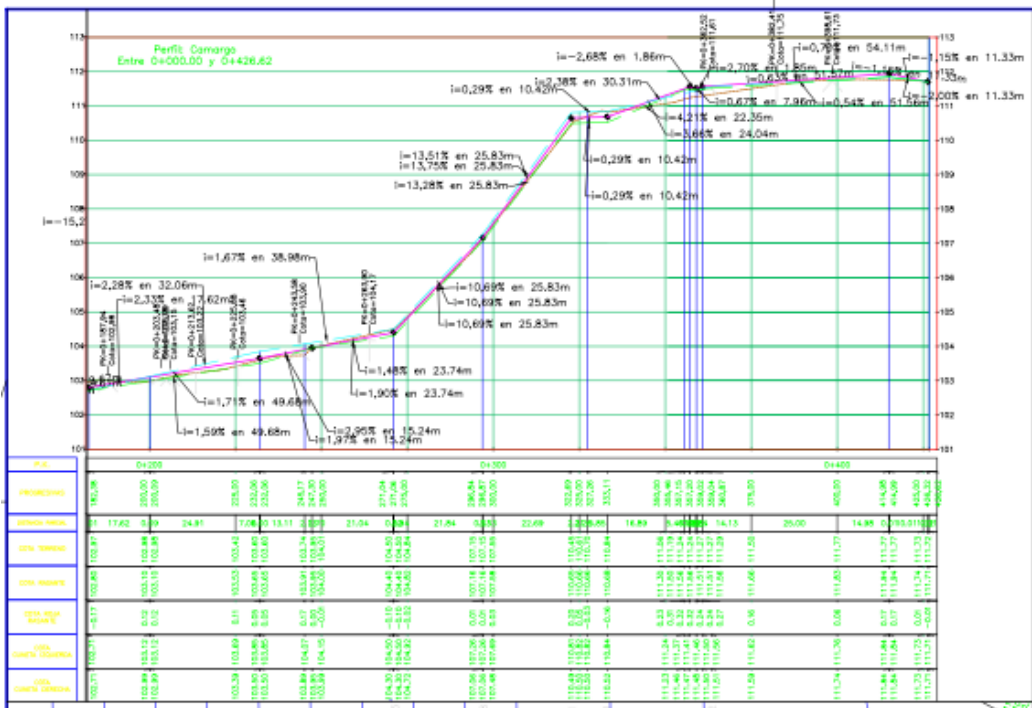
Perfil longitudinal calle Camargo entre Golgi y Ramón y Cajal.
